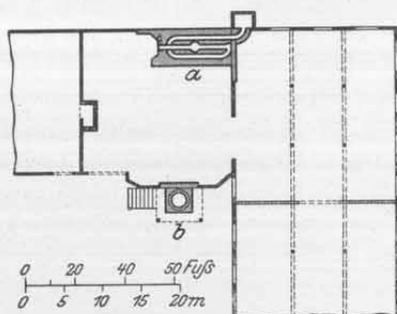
Plan der Klettschen Maschinenfabrik 1841.
